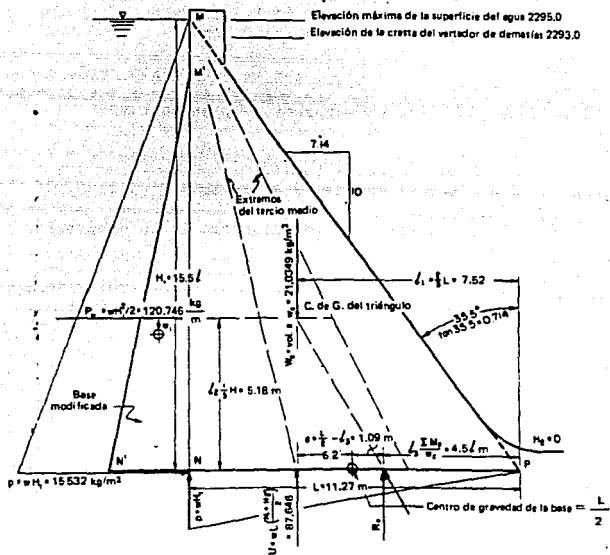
Sección transversal del bloque central de una presa de gravedad de concreto.
